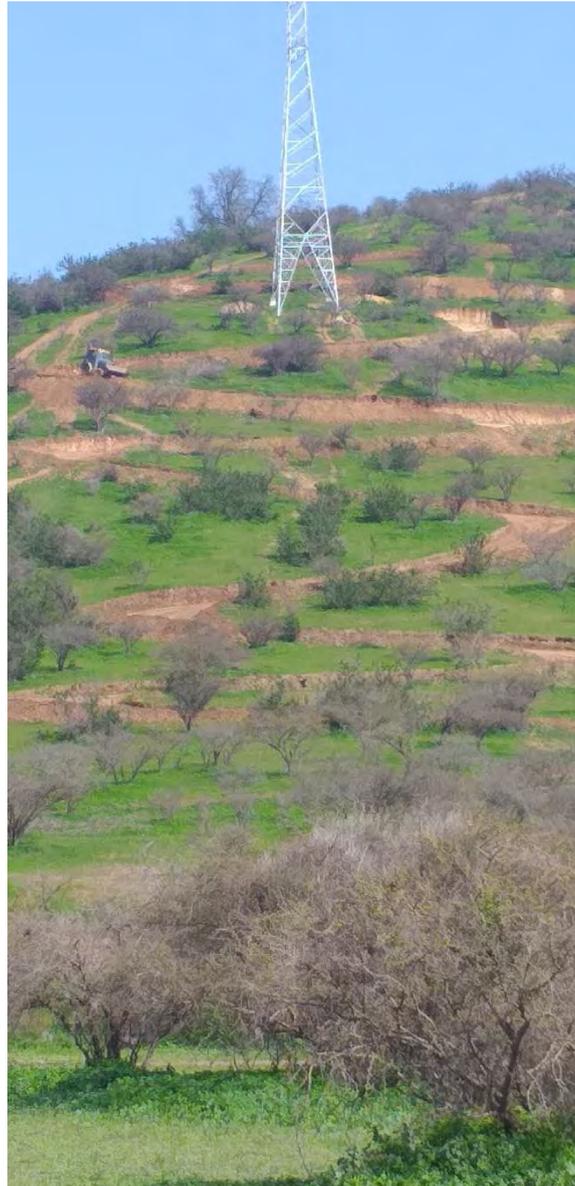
Siembra semillas estructuras 3 y 3B SECC
